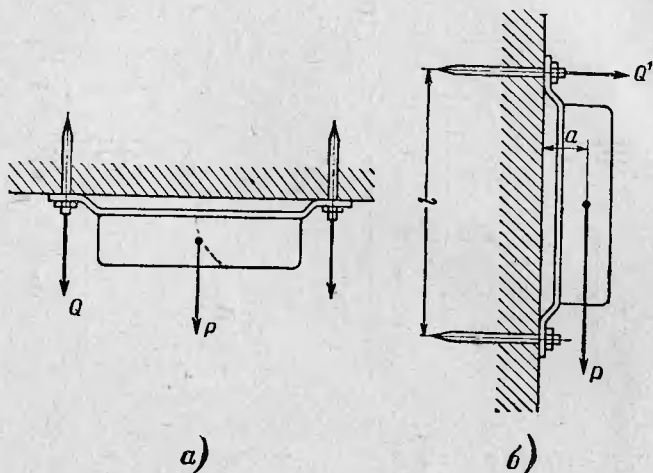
Расчетные схемы усилий, действующих на дюбеля при креплении конструкций к потолку и стене.
